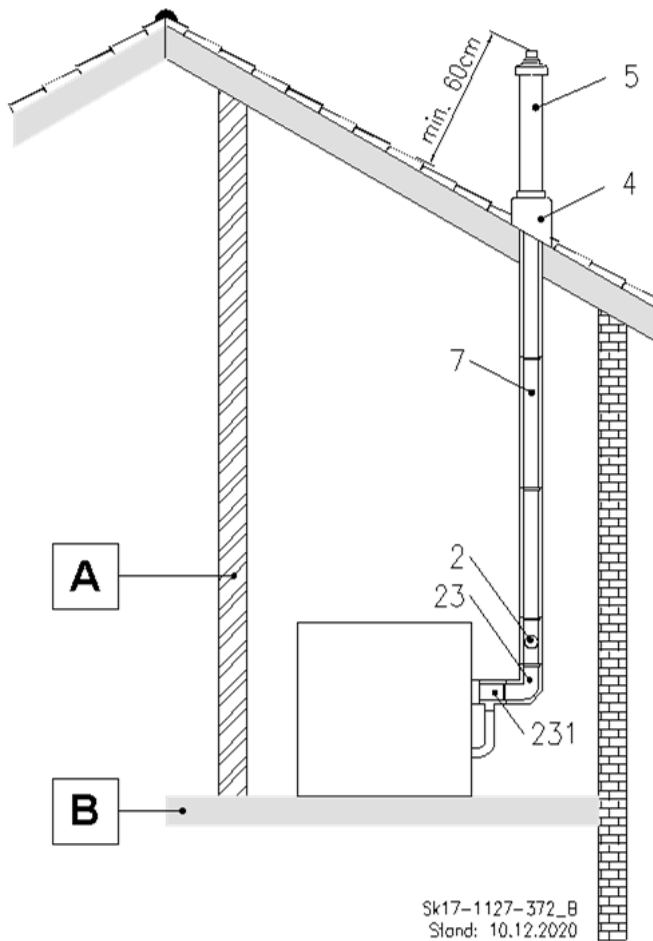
C_{33x} Centrale de chauffage de toit avec modèle vertical traversant un toit incliné
